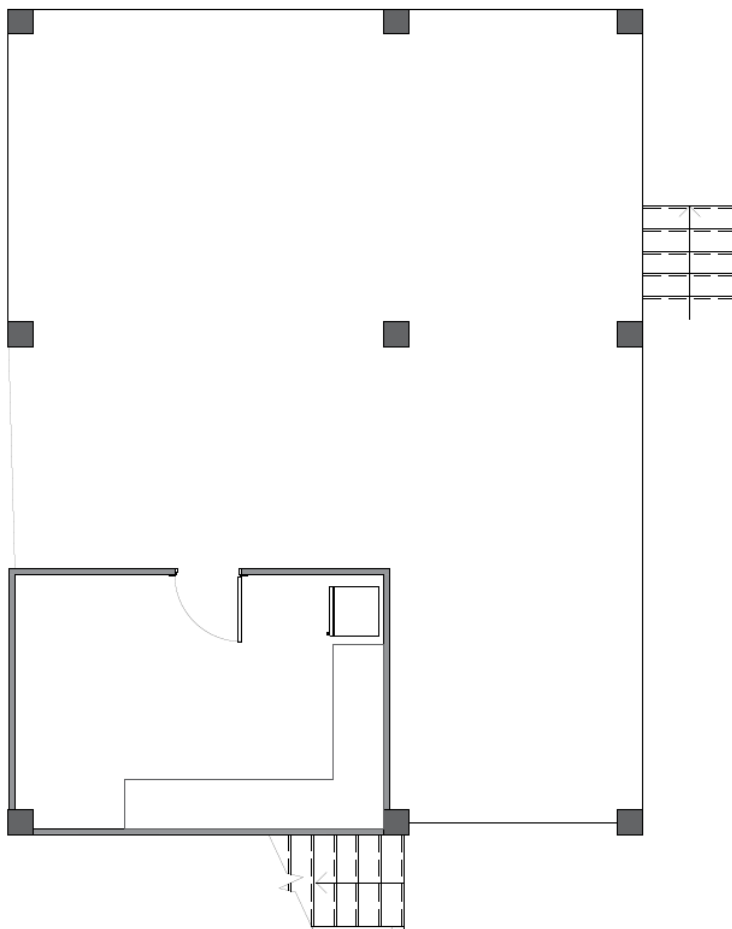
Plano estado actual de la vivienda - planta baja. Fuente propia
